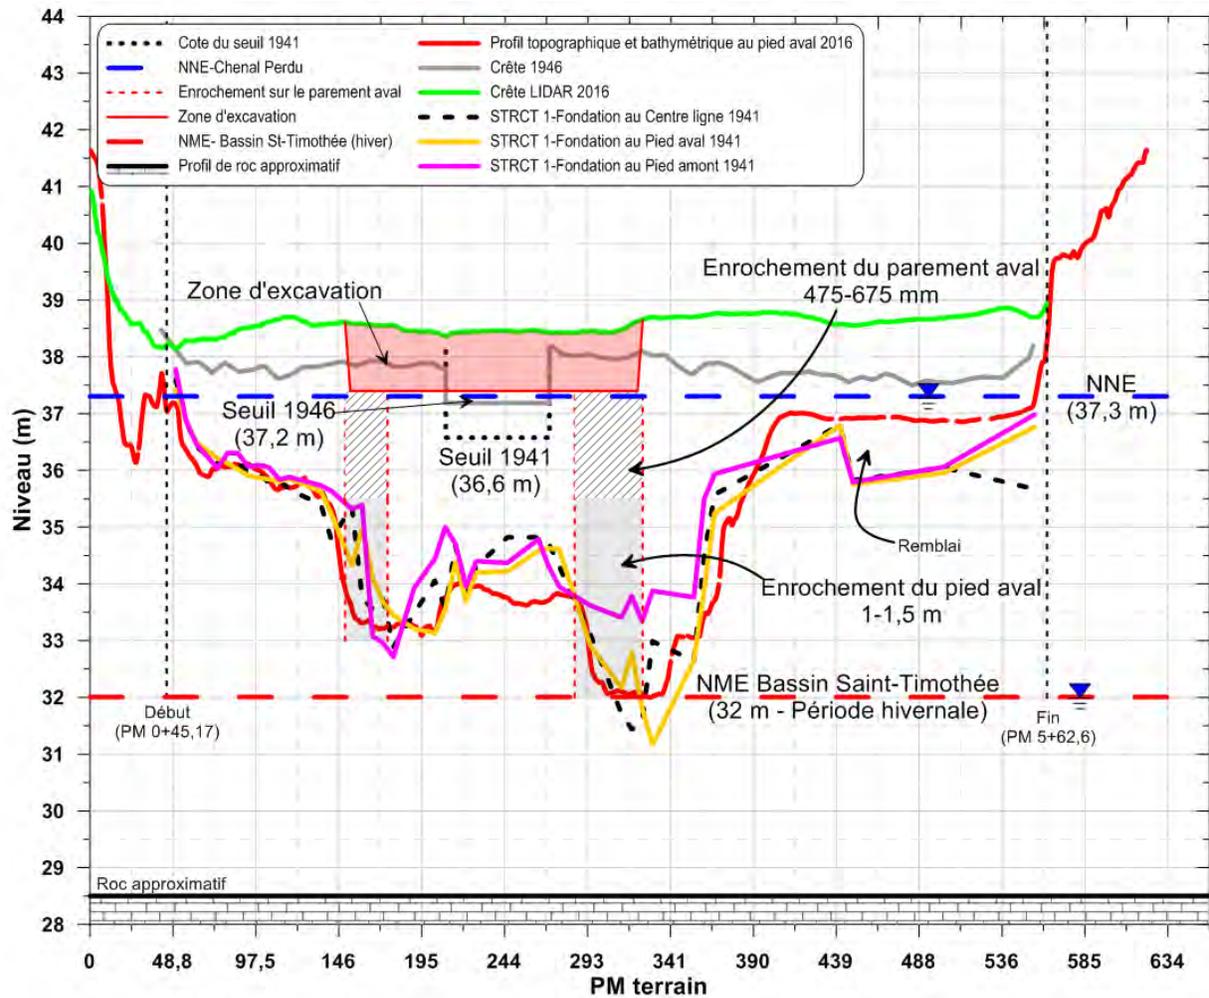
Proposition de travaux temporaires à la Structure 1 – coupe longitudinale
